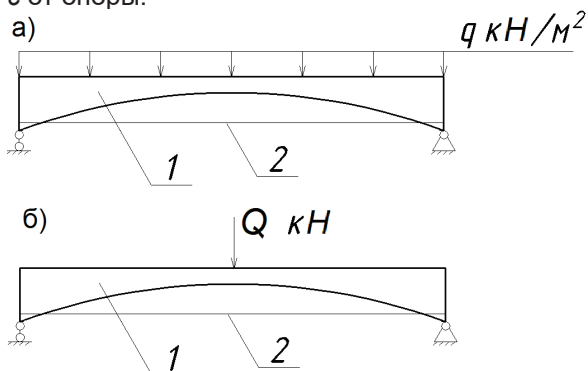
Испытательная схема арочного фрагмента перекрытия:
